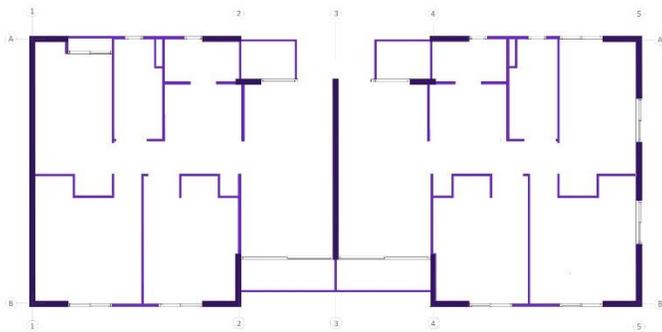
Estructura Villa Parque. Fuente: Elaboración propia
